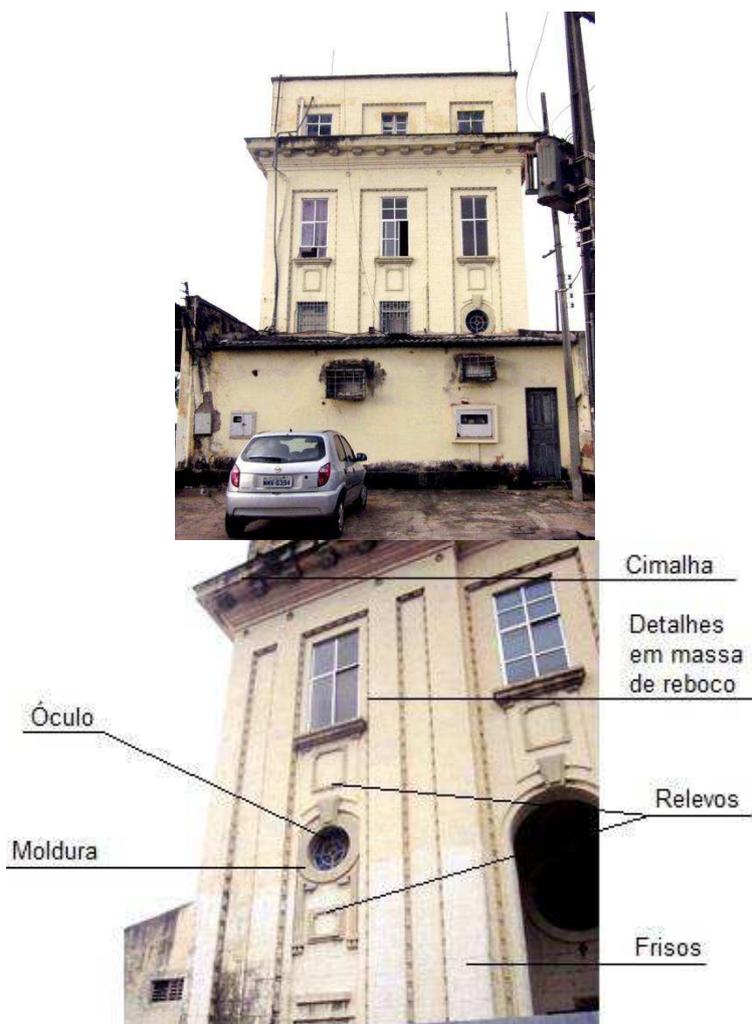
e fig. 47 – Fachada lateral hoje parcialmente coberta por um anexo e vista dos elementos que ornamentam as fachadas.
